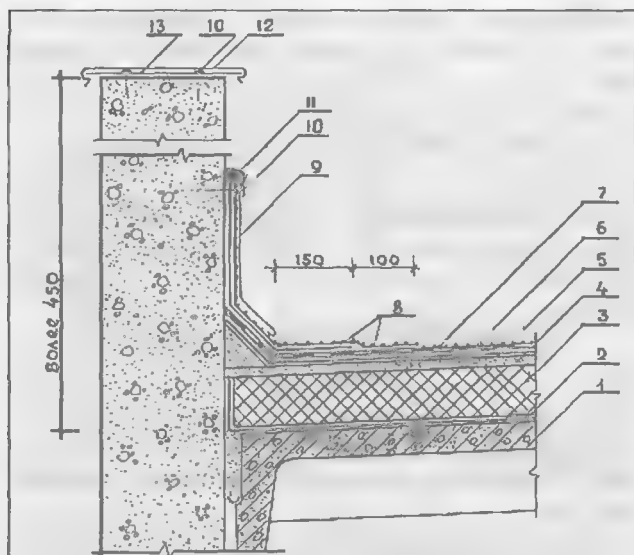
Примыкание кровли к парапету высотой более 450 мм:
